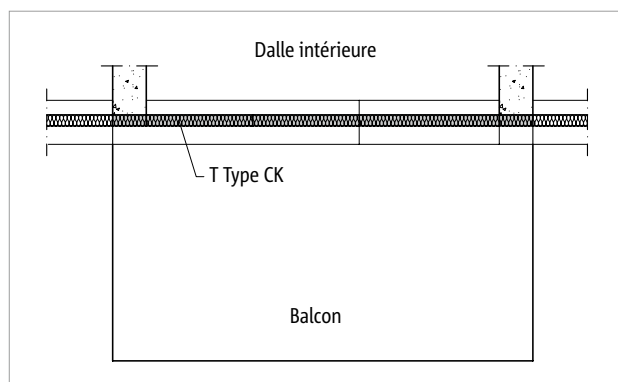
Schöck Isokorb® T Type CK : balcon en porte-à-faux
